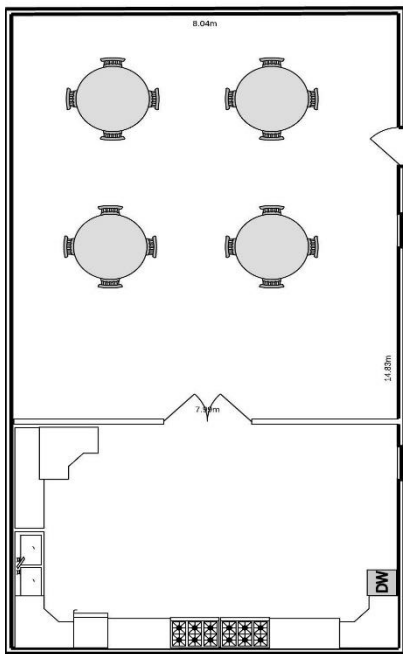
Plano de cómo serían las instalaciones ya refaccionadas.
